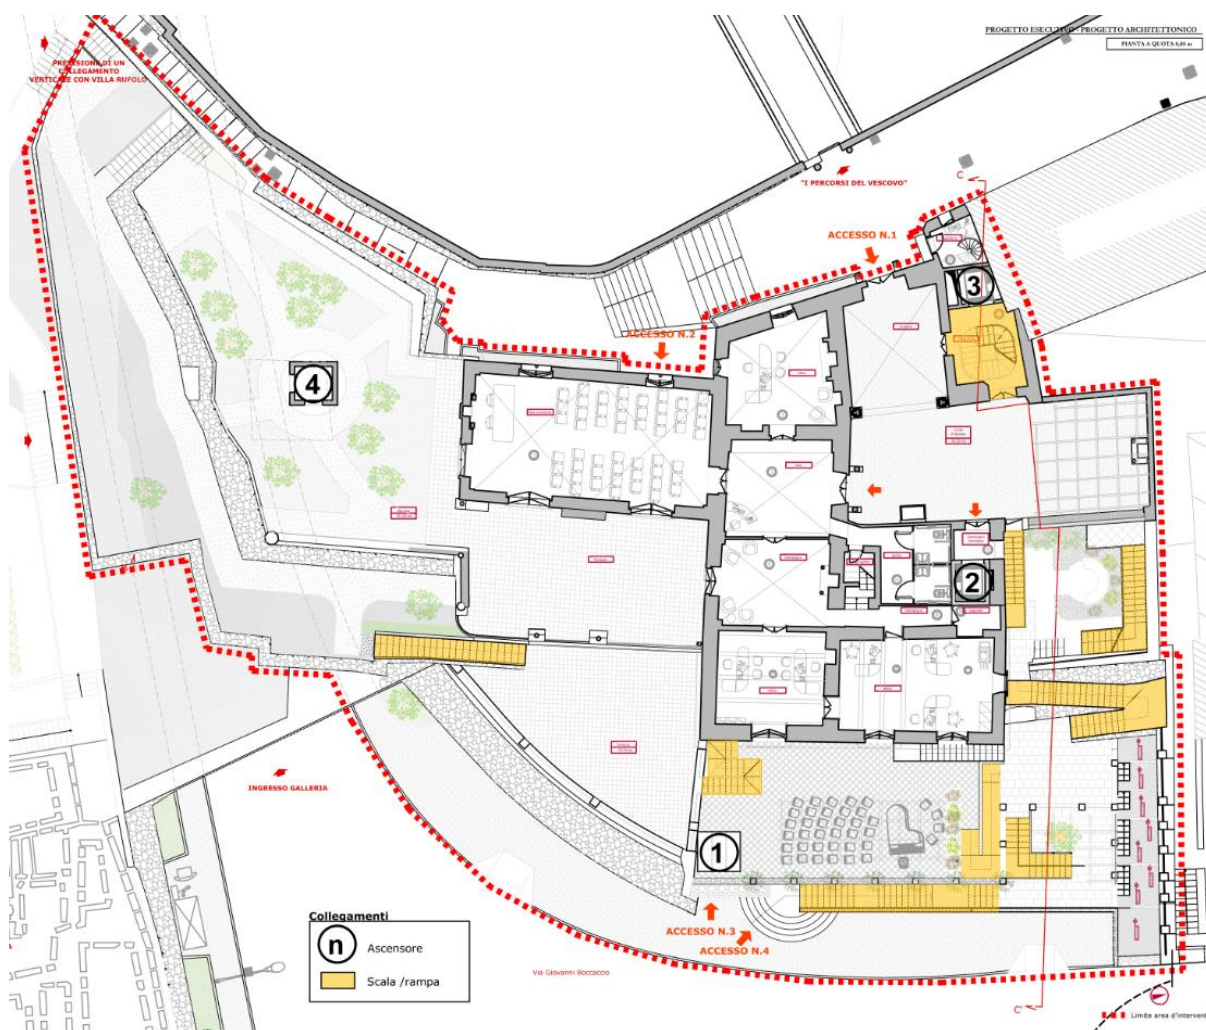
Collegamenti verticali – Planimetria a qt.0.00
